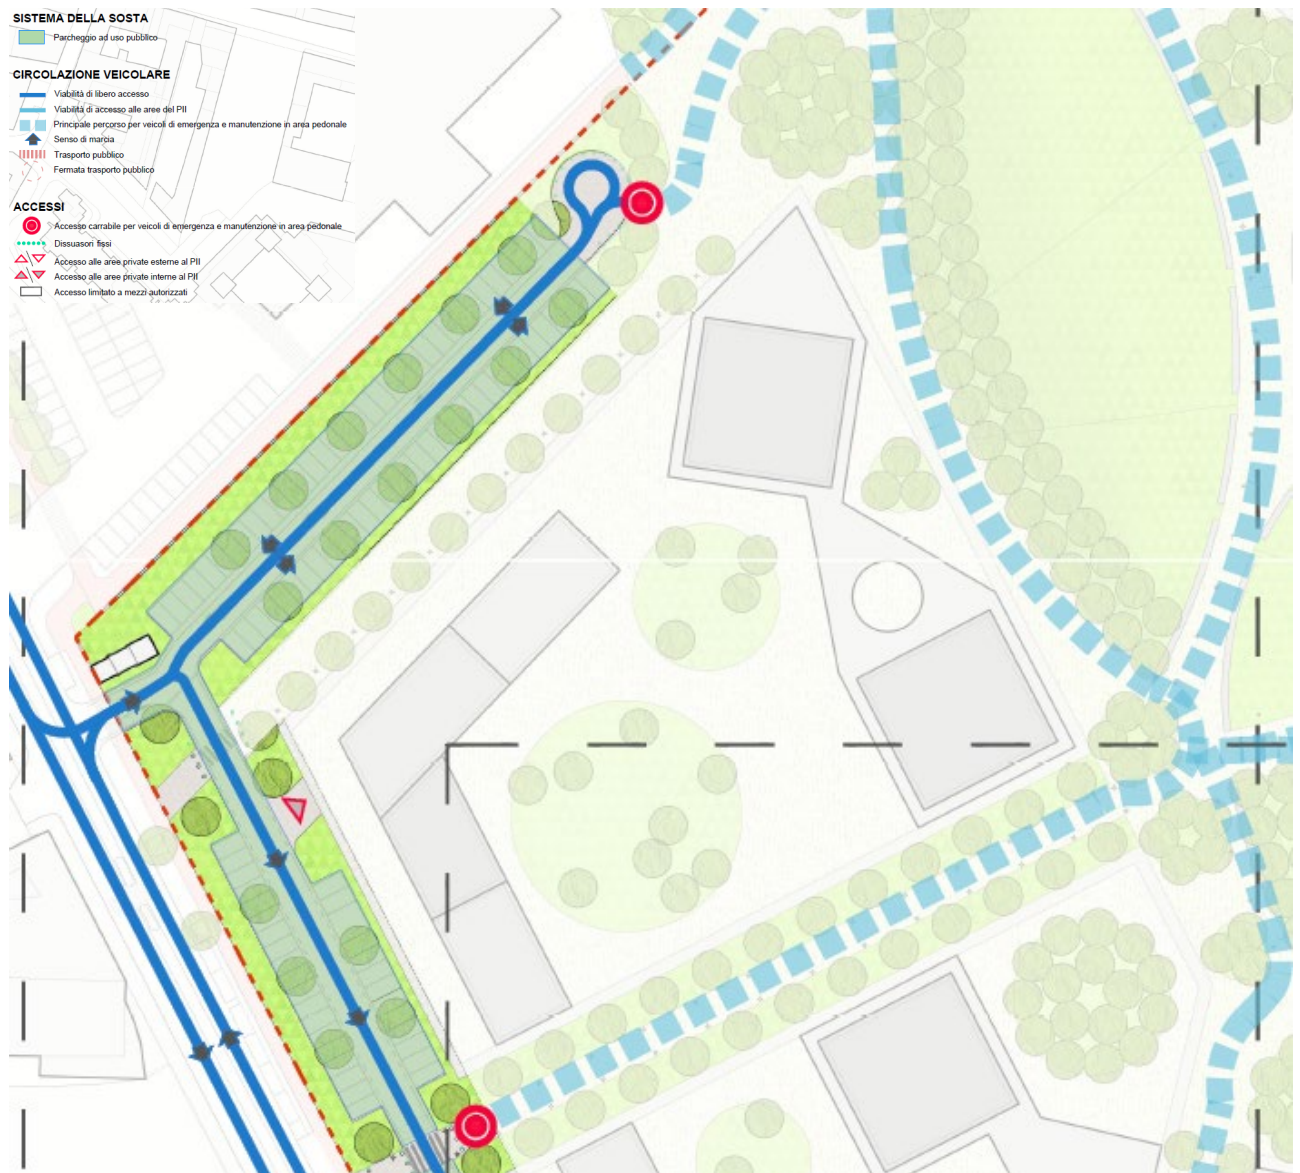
Schema di circolazione e IN-OUT da carrai delle autovetture
